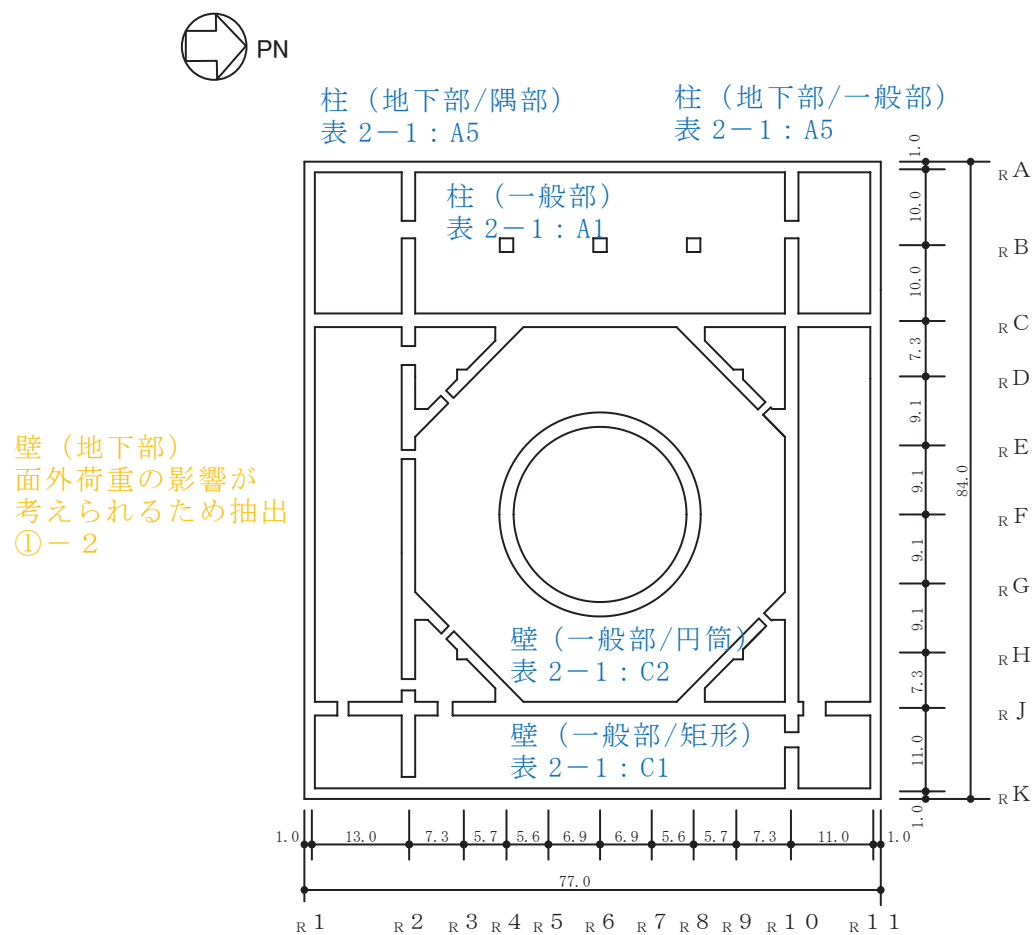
(1) 原子炉建屋の概略平面図 (O.P.\*-8.1m)
